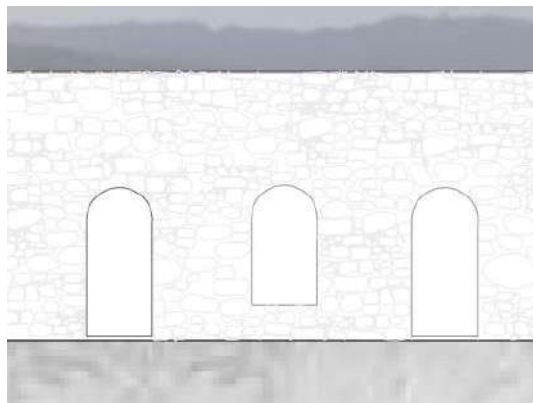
Secção que demonstra a pedra existente ao longo das paredes de betão
